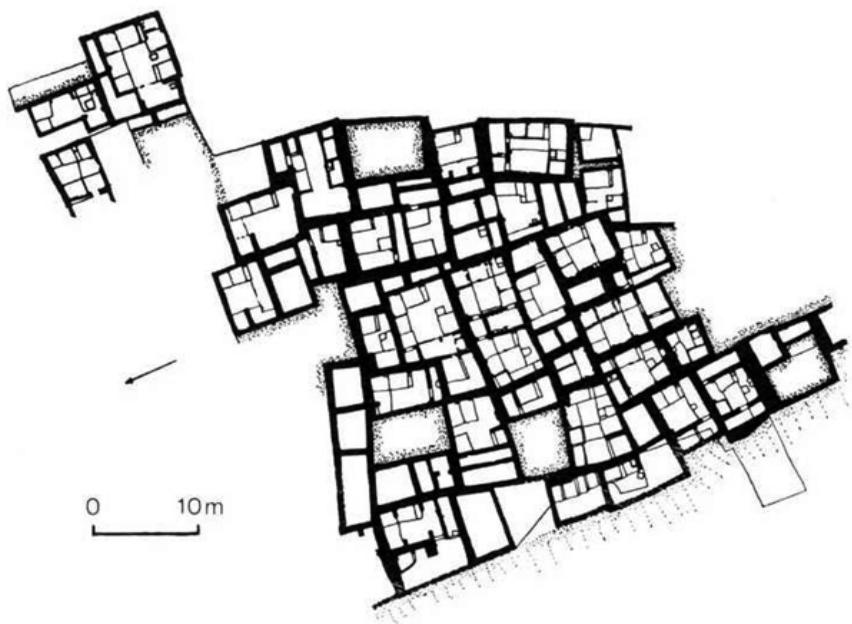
Çatal Hüyük, planta de yacimiento de algunas de las estructuras halladas en el poblado neolítico, según J. Mellaart. Fuente: (Bellido, 2009).
